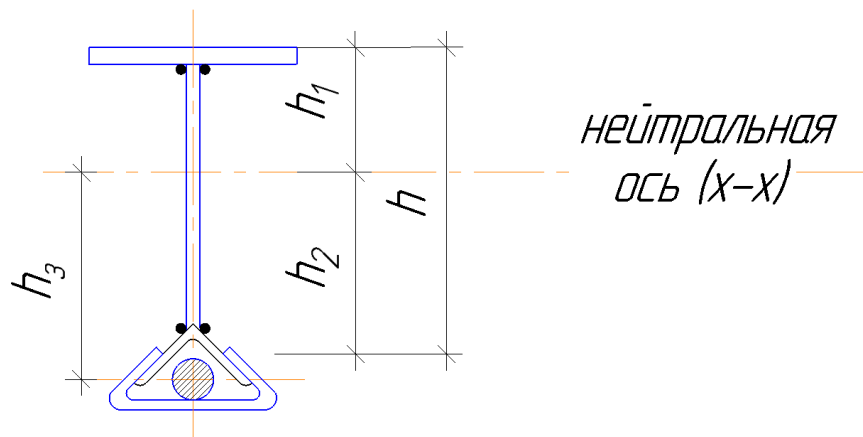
, в. Пример поперечного сечения балки с нижним поясом из уголка
